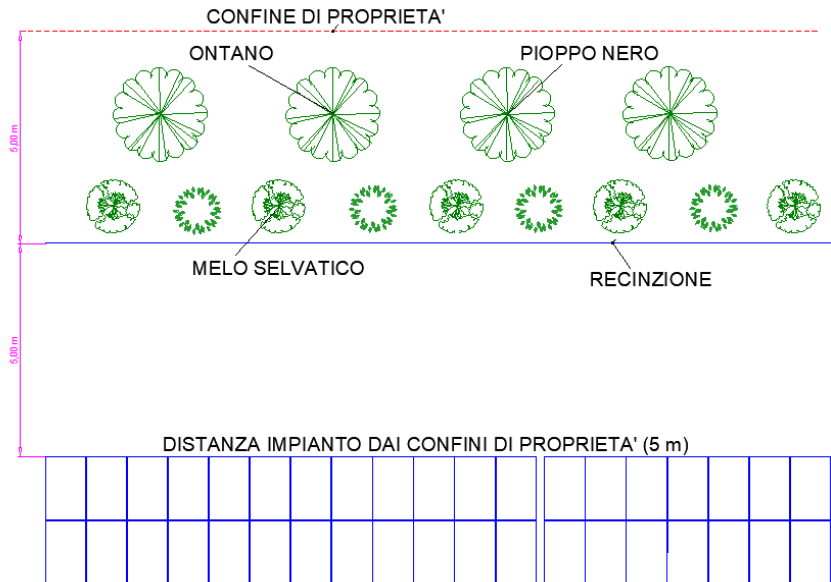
Opere di Mitigazione (Vista in Pianta fascia ripariale)
